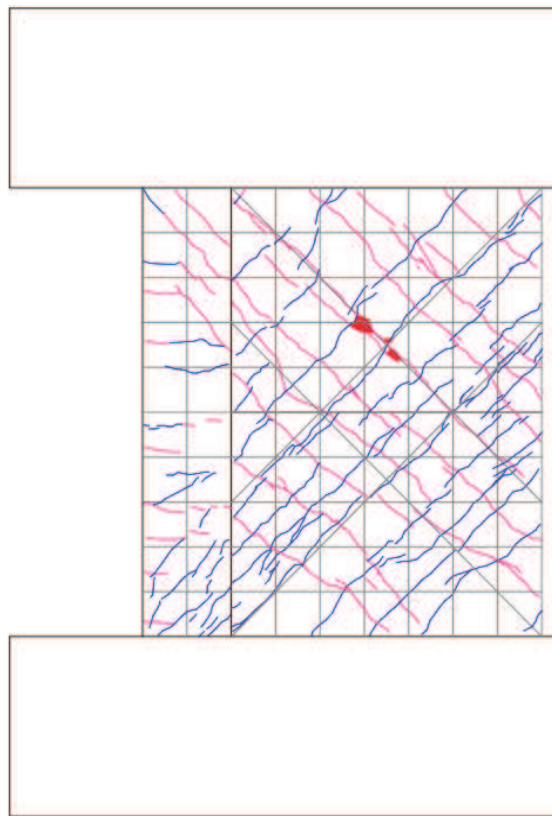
試験体 S-06-DII 6/1000rad. ひび割れ図
